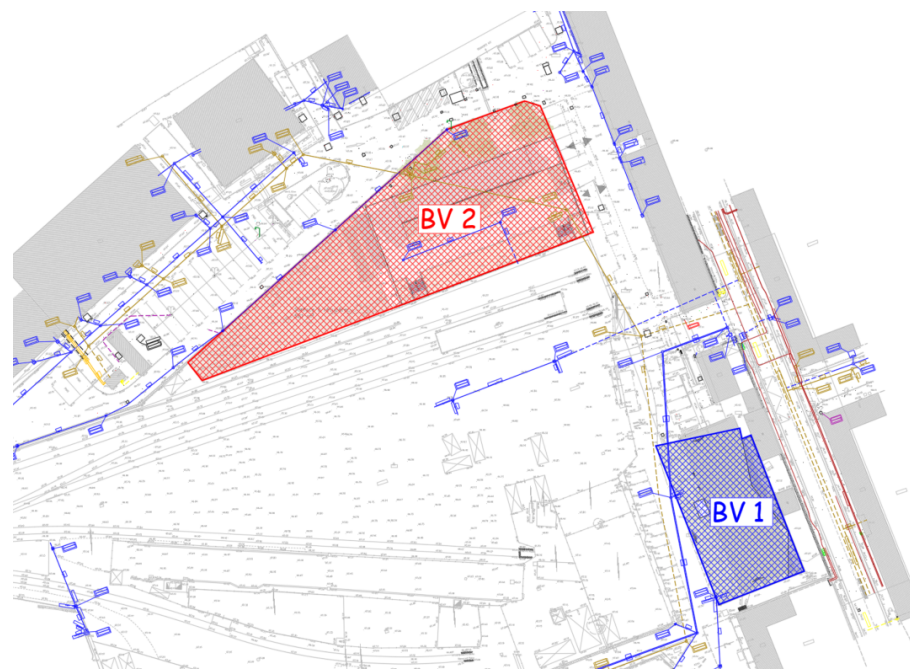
les bassins versants (toiture stockante -Bâtiment Cour des Pierres et chaussée drainante au niveau du parking de plain-pied)
